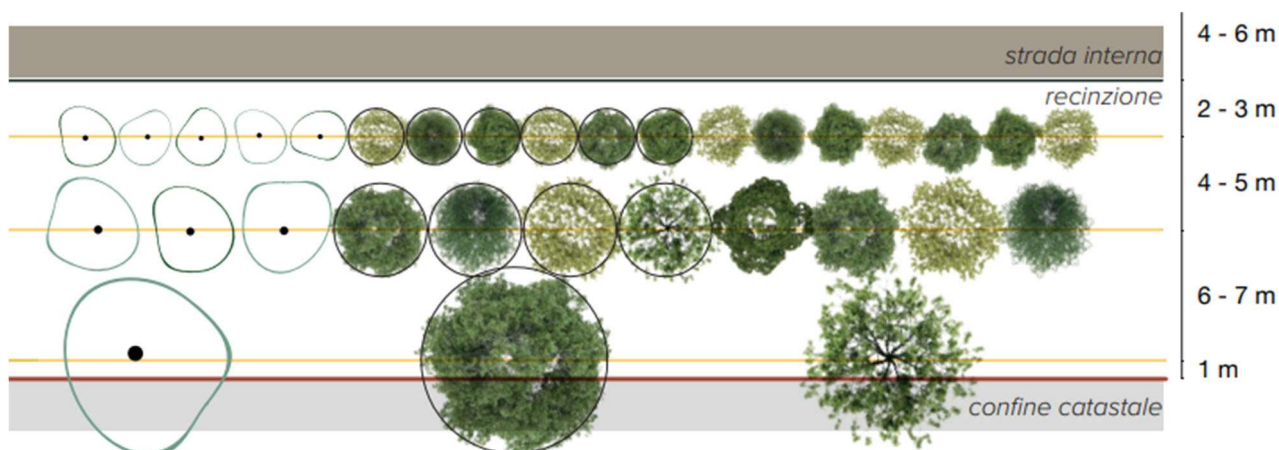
Fascia vegetata a tre file parallele sfalsate prevista dal progetto
